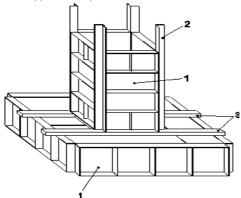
Схема устройства опалубки столбчатого фундамента 1 — щит; 2 — наружный угол; 3 — балка
